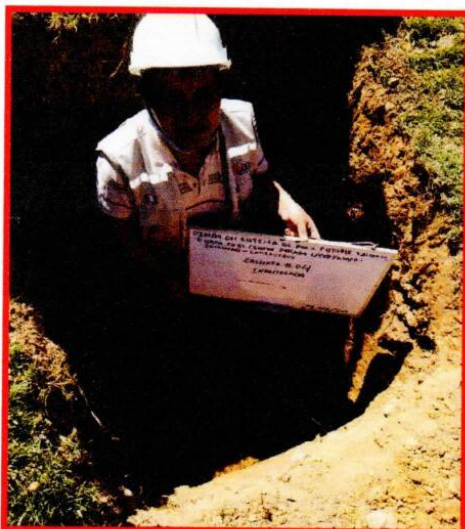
Detalle del perfil del suelo en calicata C-4.
